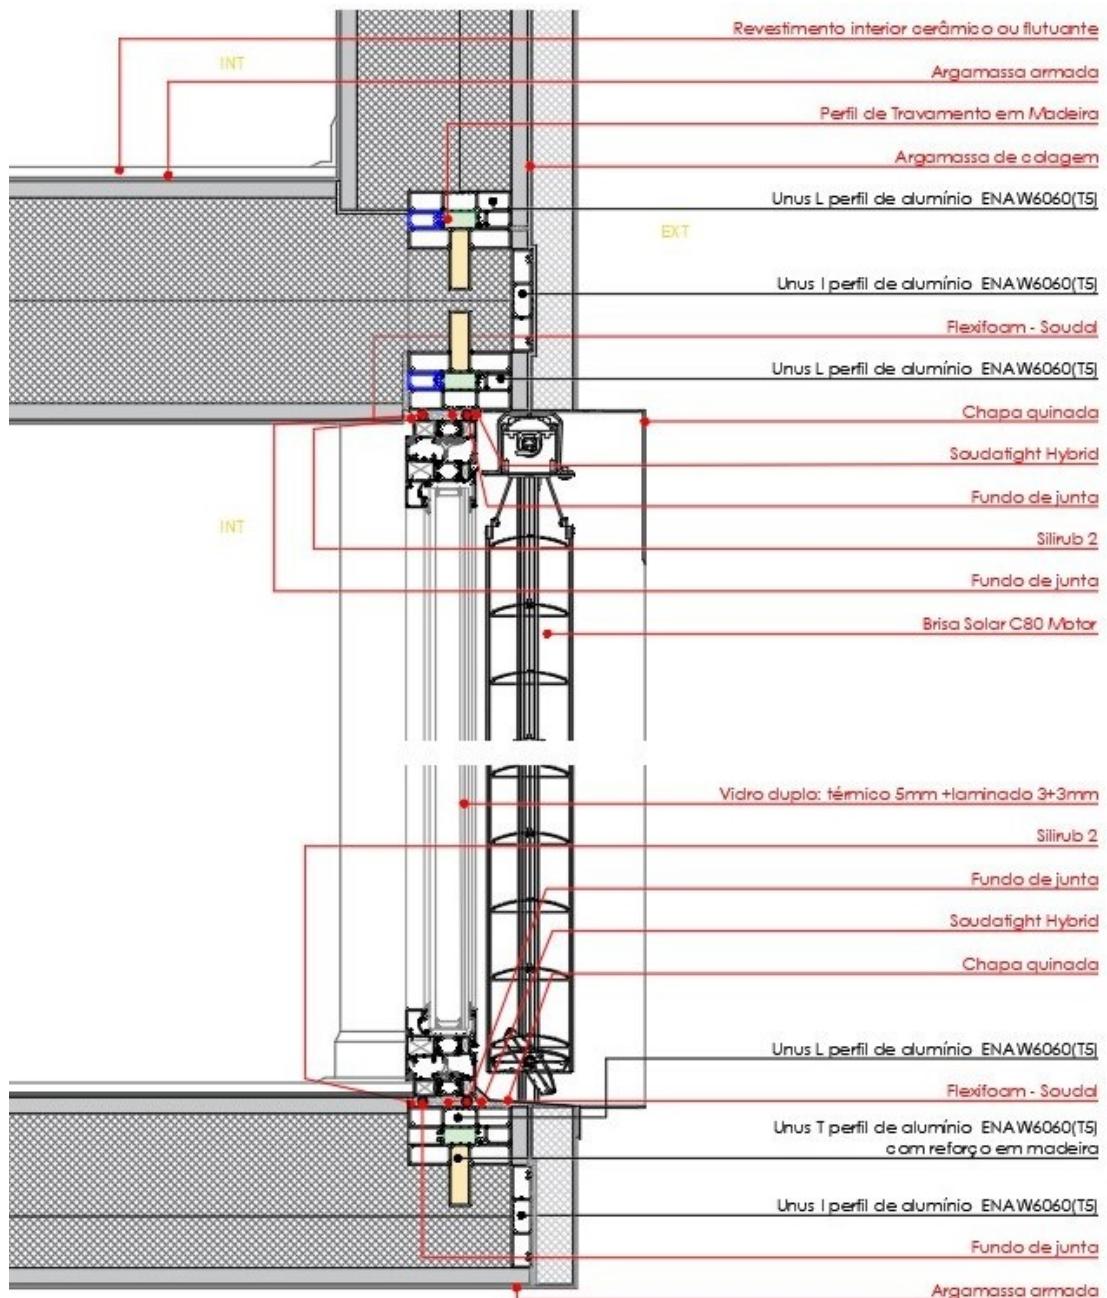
Solução Final – Pormenor construtivo de solução de vão exteriores.
